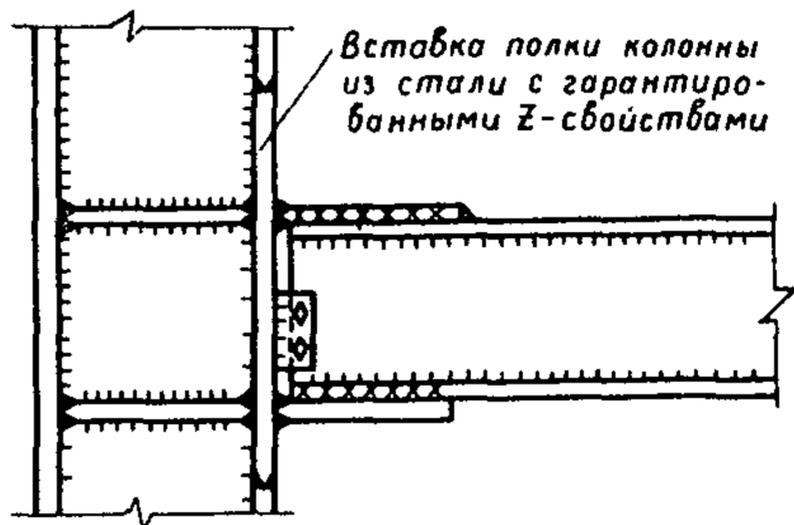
Сварной узел примыкания ригеля к колонне со вставкой полки колонны из стали с гарантированными Z-свойствами
